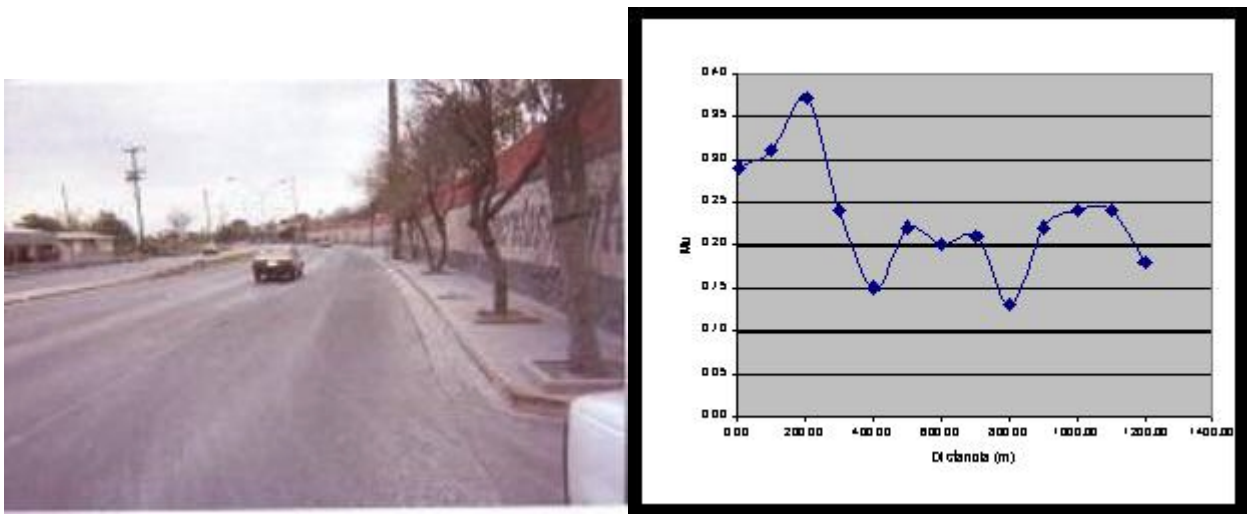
Pavimento de Asfalto Convencional, Avenida Morones Prieto.
